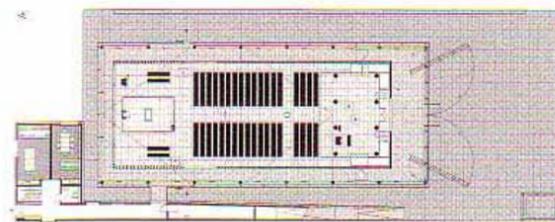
Grundriss Herz Jesu Kirche, München, 2002
